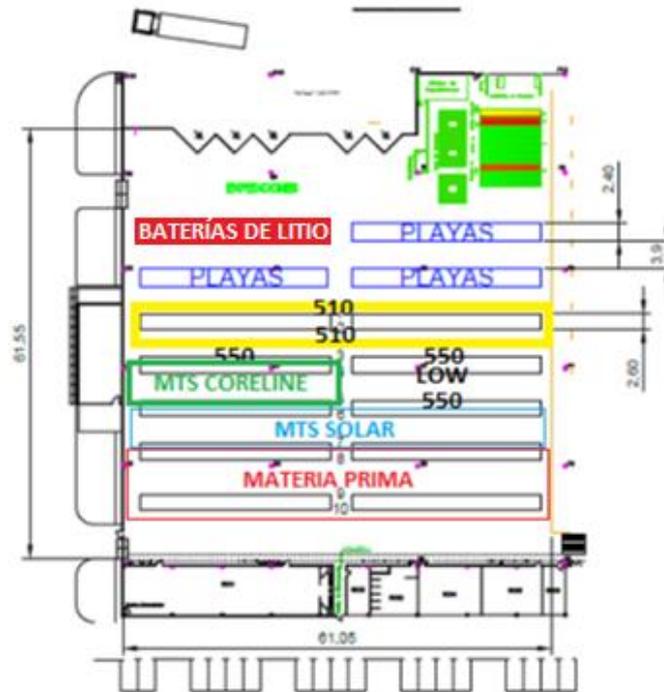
Propuesta layout almacenamiento baterías de litio
